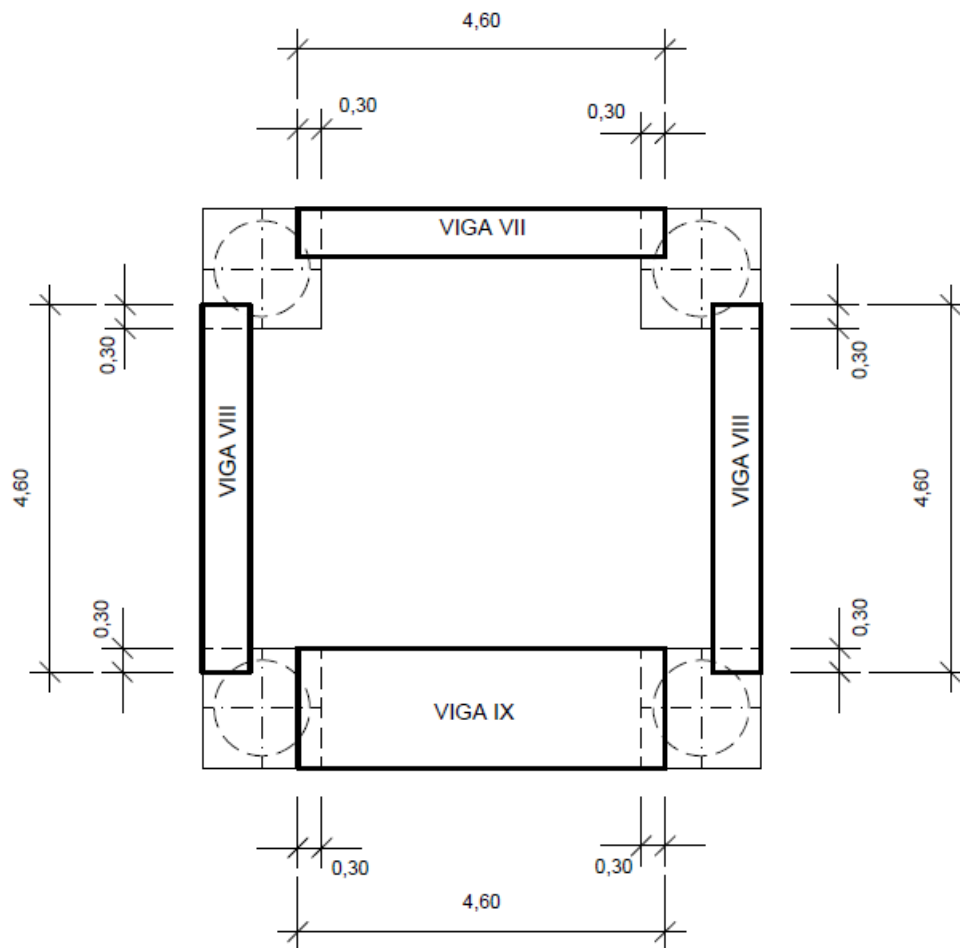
Disposición de las vigas prefabricadas sobre capiteles.
